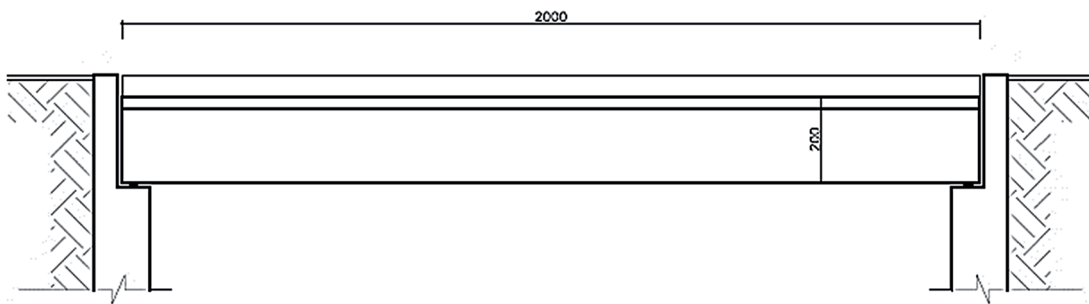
Esquema longitudinal de ponte TB-450 (medidas em cm).
